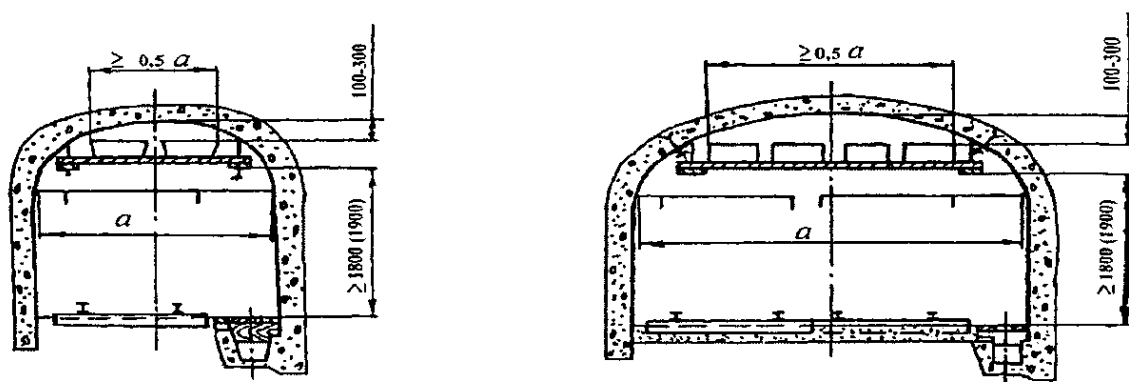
Схема установки водяных заслонов в выработках, закрепленных бетонной крепью
